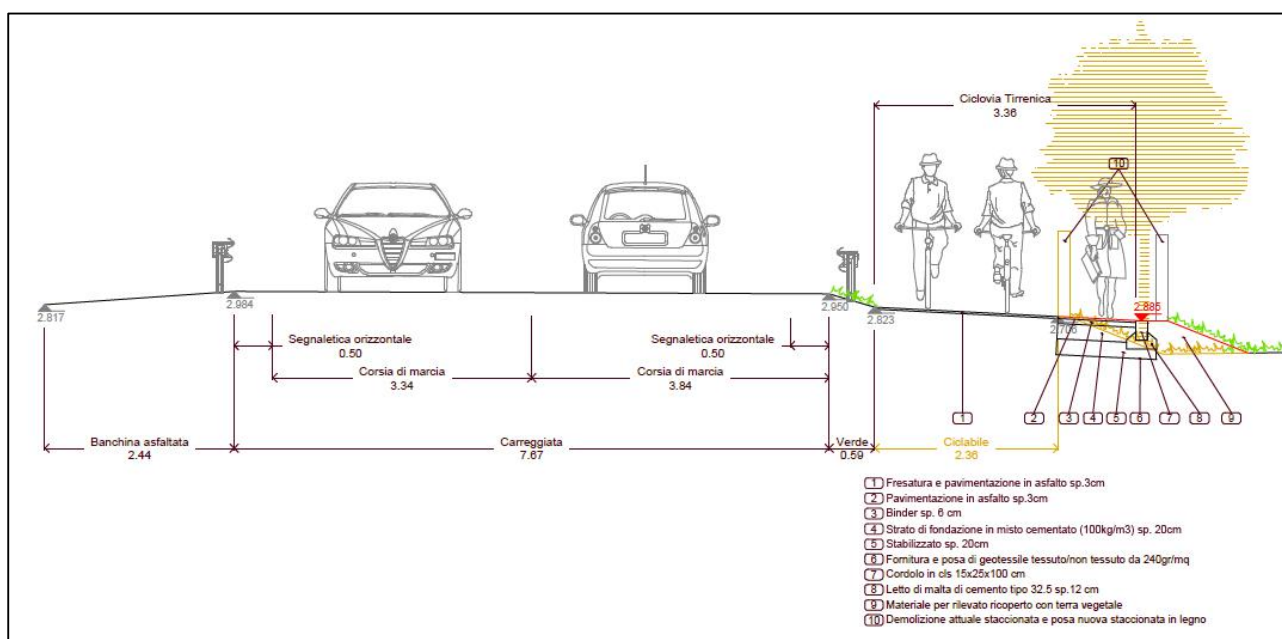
Sezione 22 di progetto trasversale SP delle Collacchie
